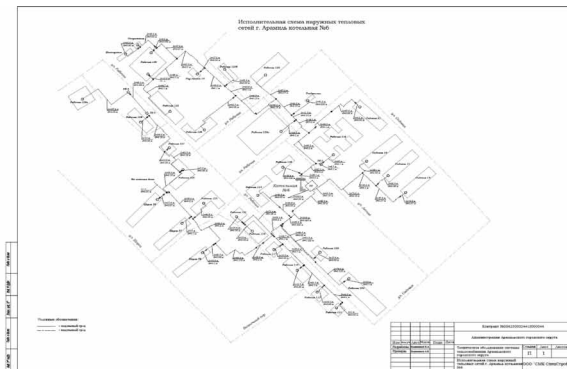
Исполнительная схема наружных тепловых сетей котельной №6
